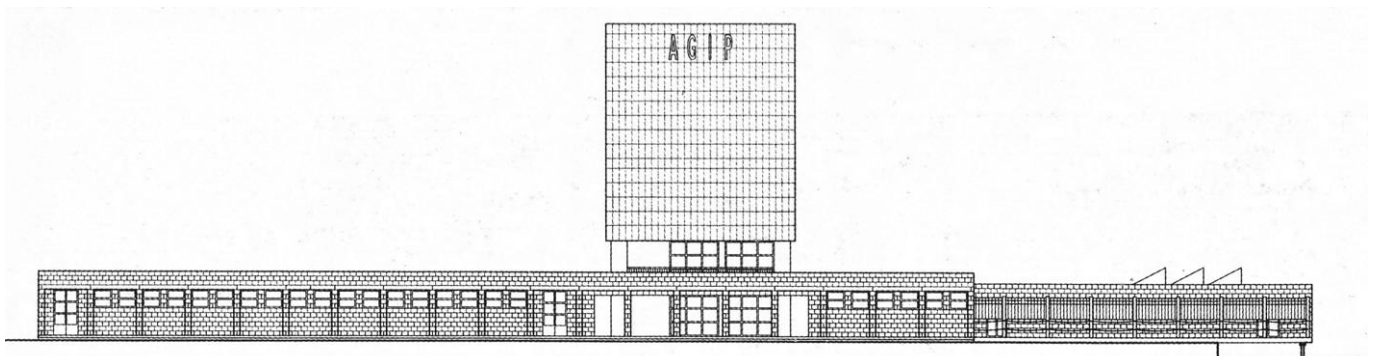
prospetto sud-ovest, lato strada, 1938, Archivio Vaccaro
